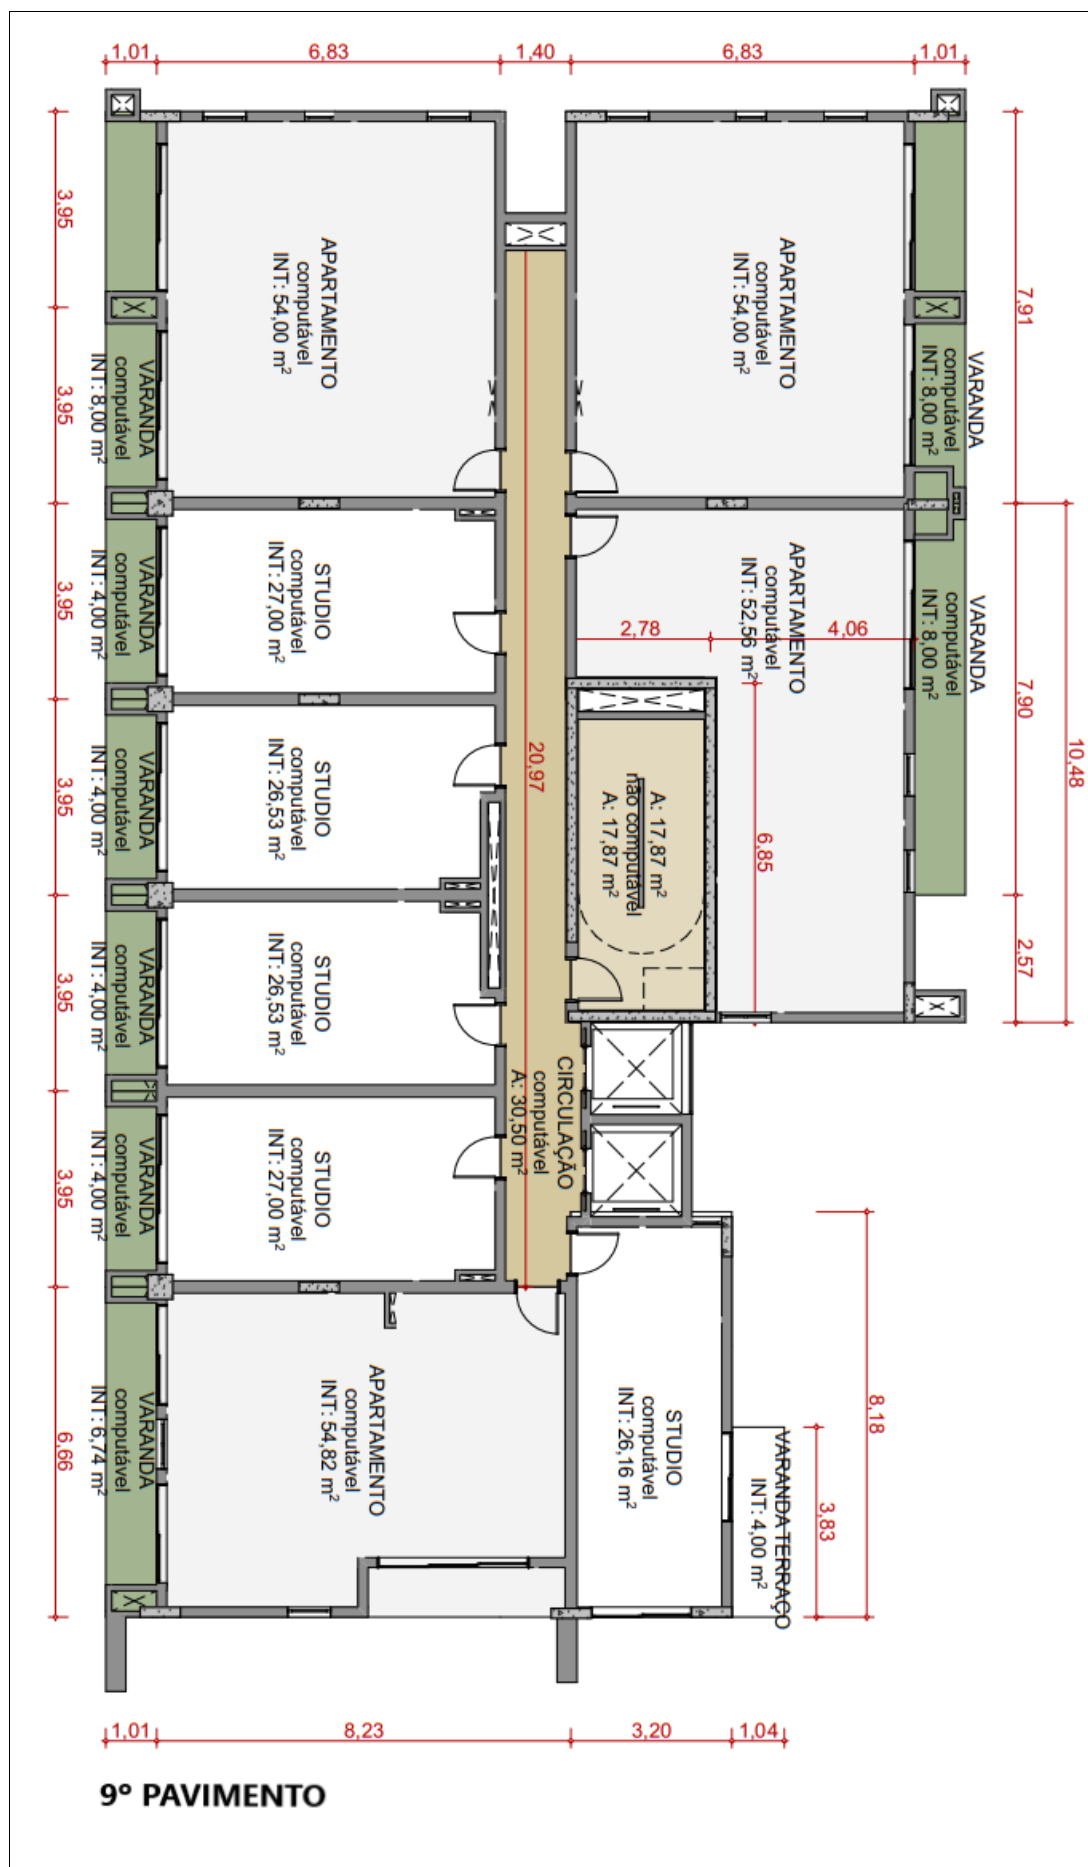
Planta do 9º Pavimento do Condomínio Sintropia Sky Garden.
